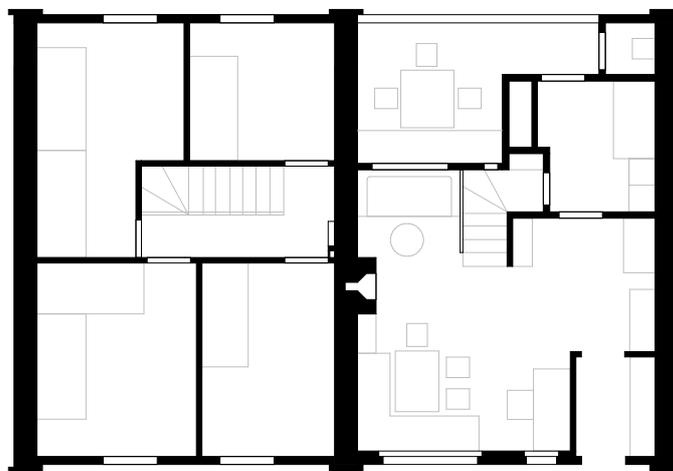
Haus mit einer Mauer, Grundriss Obergeschoss, Erdgeschoss
